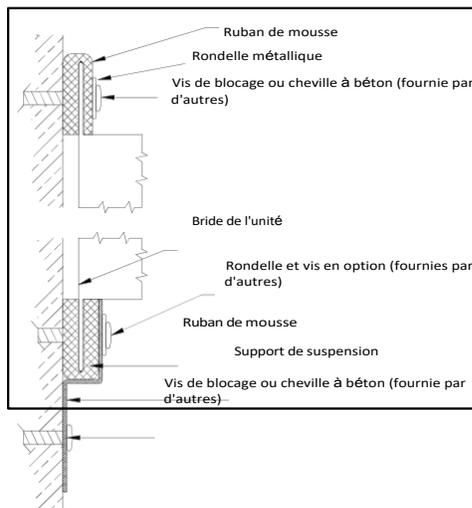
MONTAGE DE L'ERV SUR UN MUR D'OSSATURE
